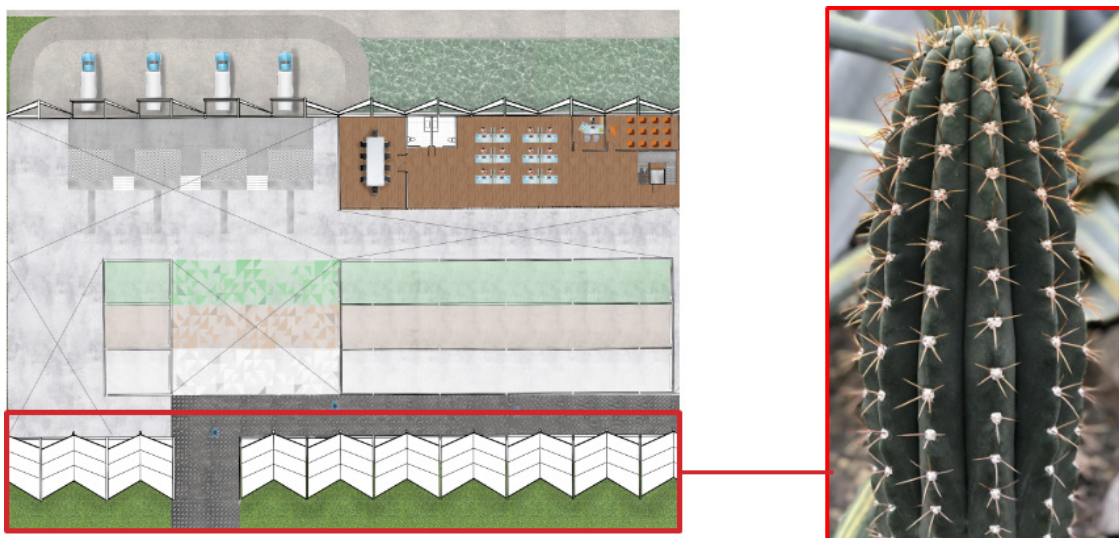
Planta baixa do galpão principal e referência para a sua fachada.
